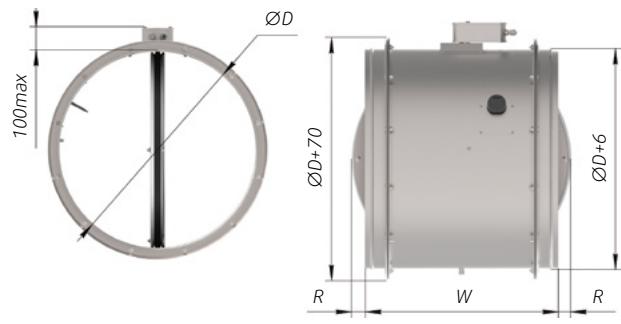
б-2 Размеры ниппельного клапана HELMER 630-1000 мм, EI60
